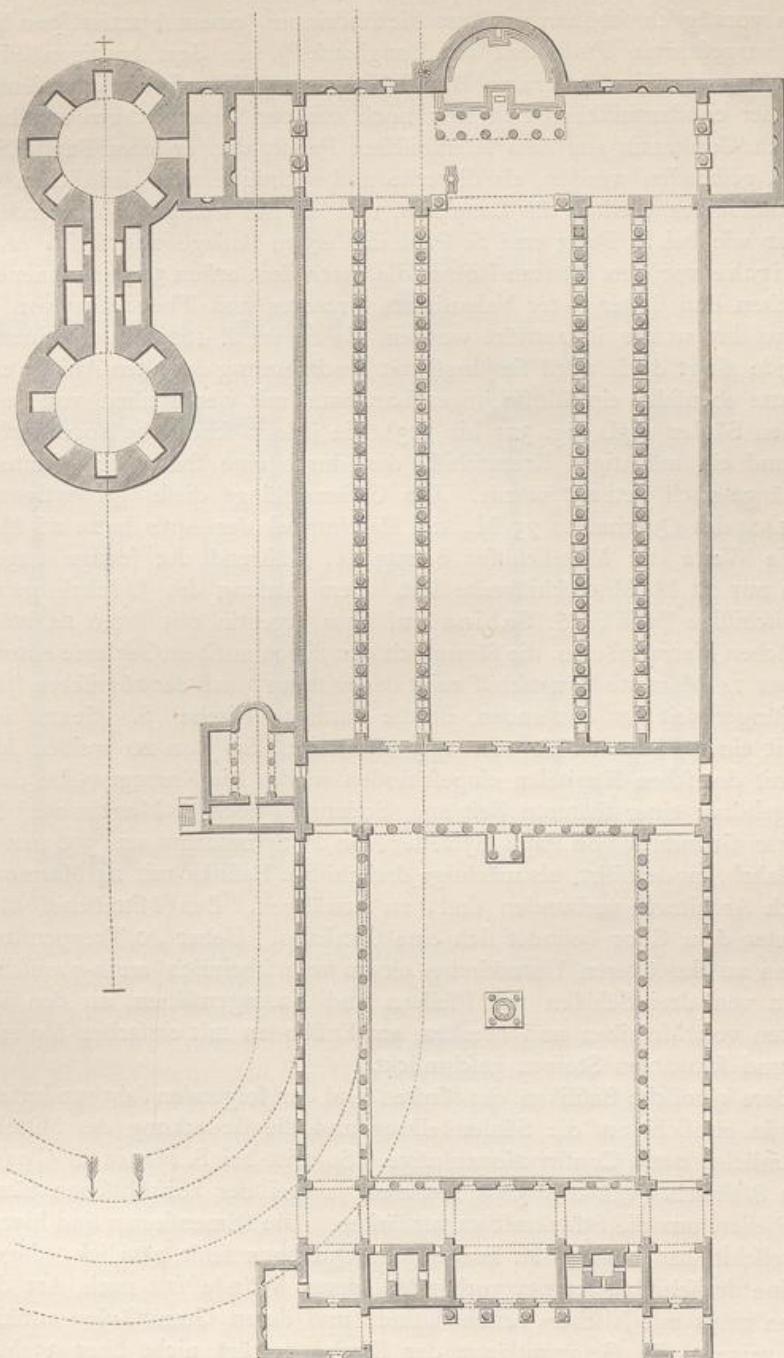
Grundriss der alten Peterskirche zu Rom.
